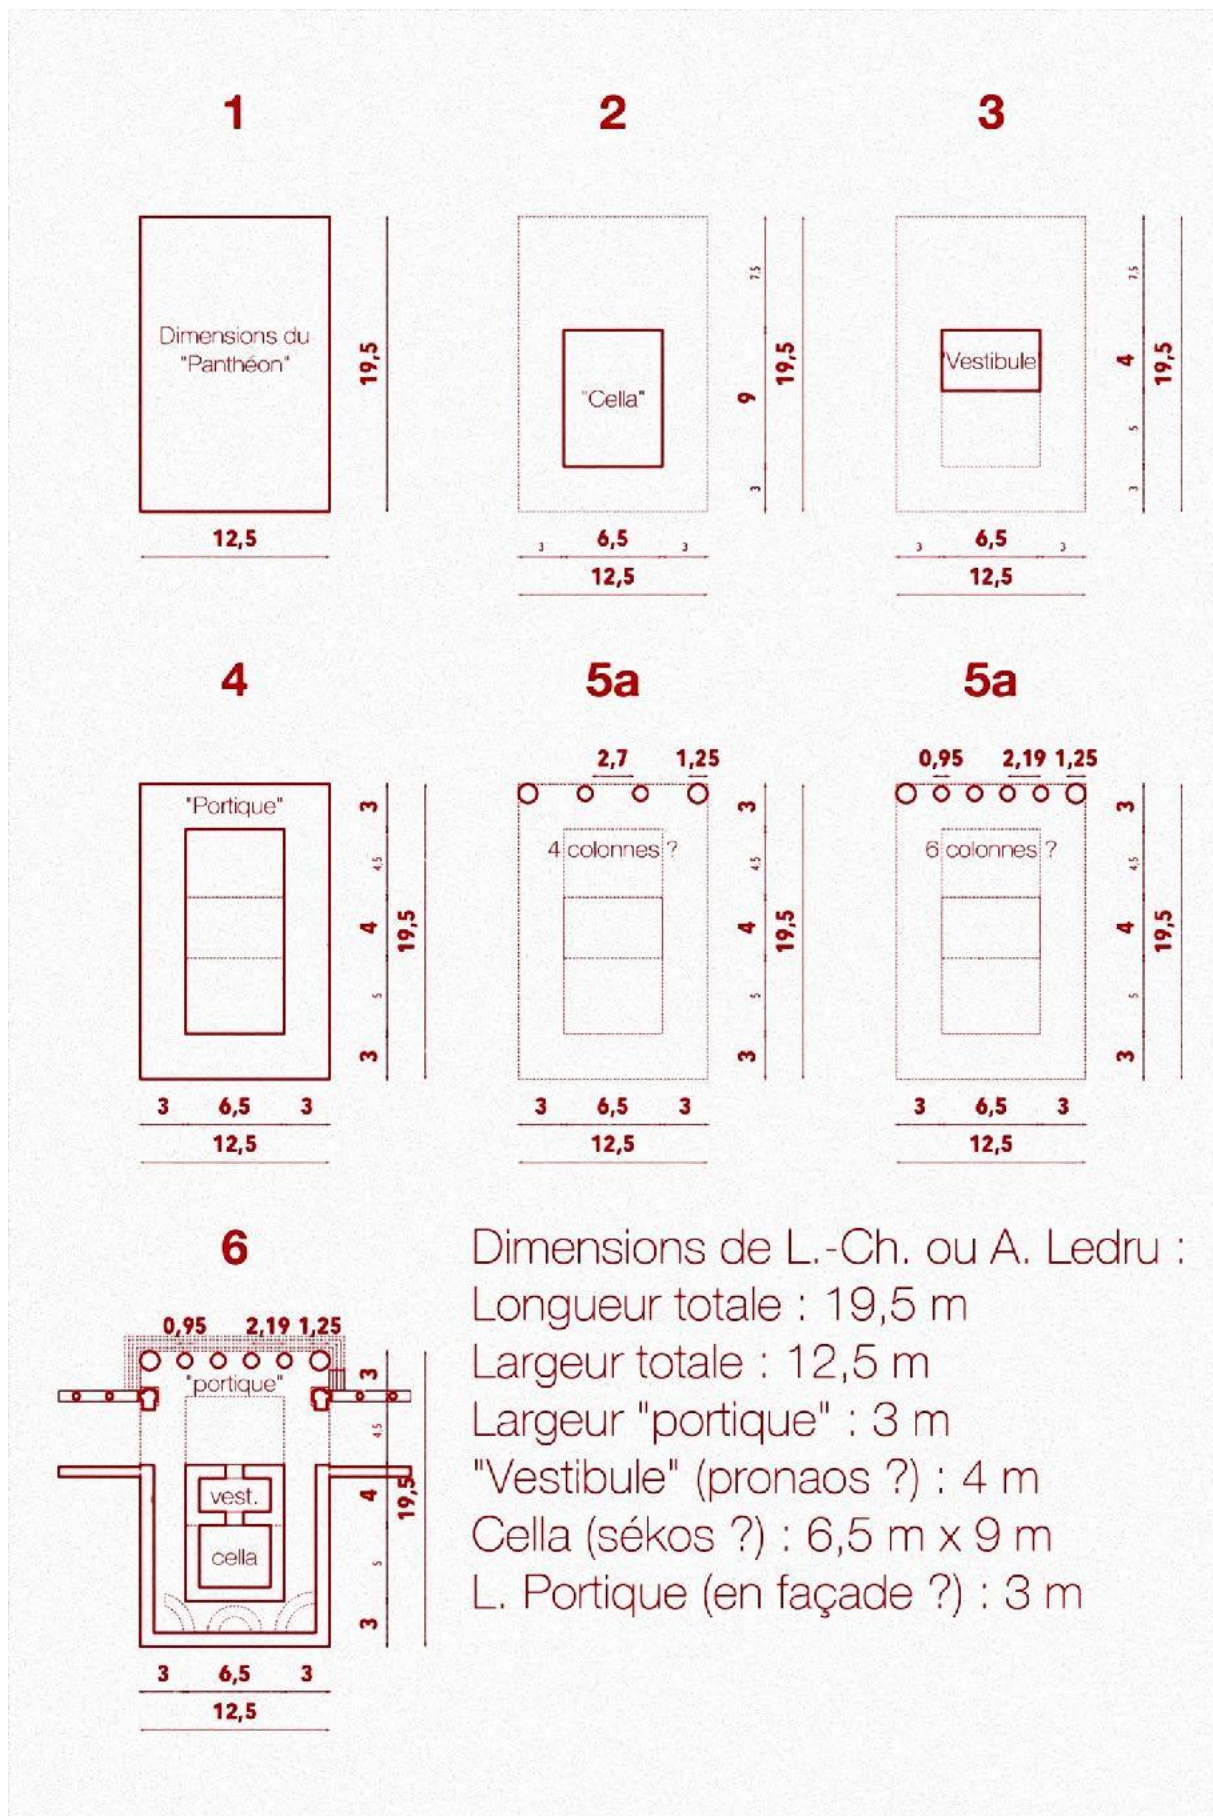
Tracé du plan du temple d'après les dimensions de Ledru (d'après M. D.-L.), 1/500.
